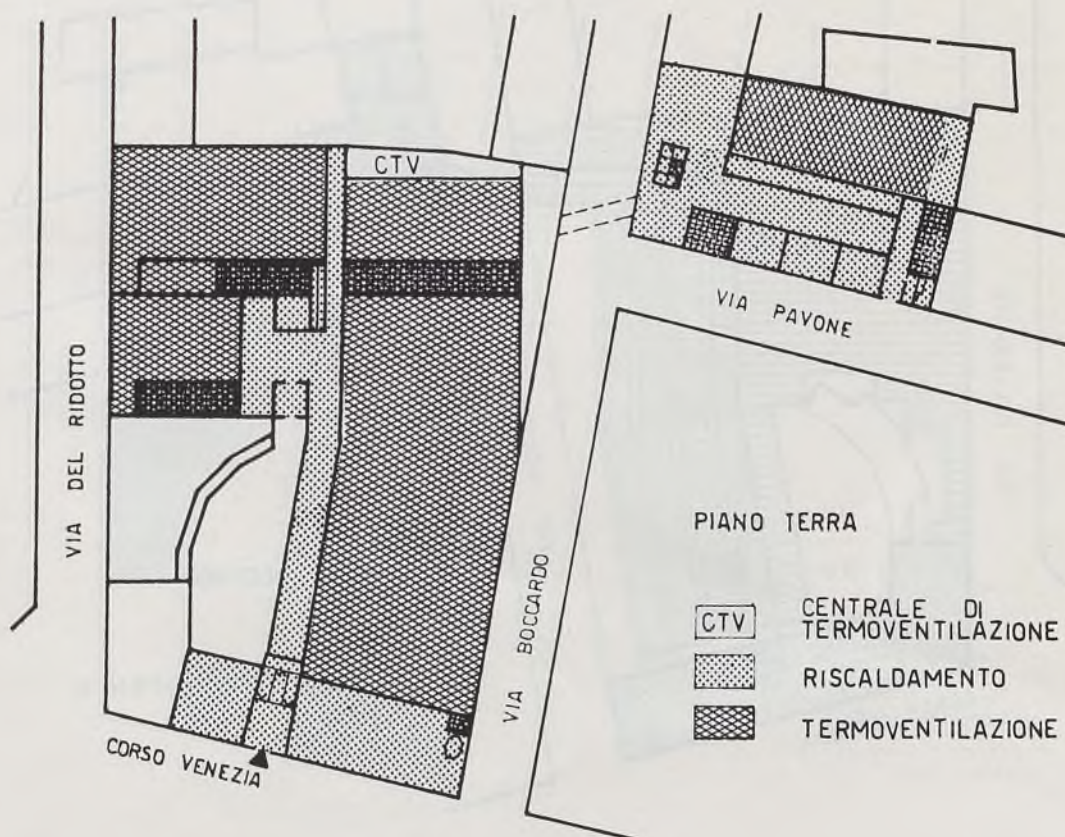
Climatizzazione - Planimetria piano terreno.
